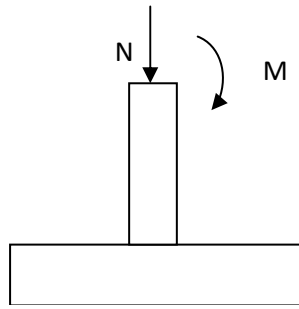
Esquema de las fuerzas de reacción en la zapatas aislada
